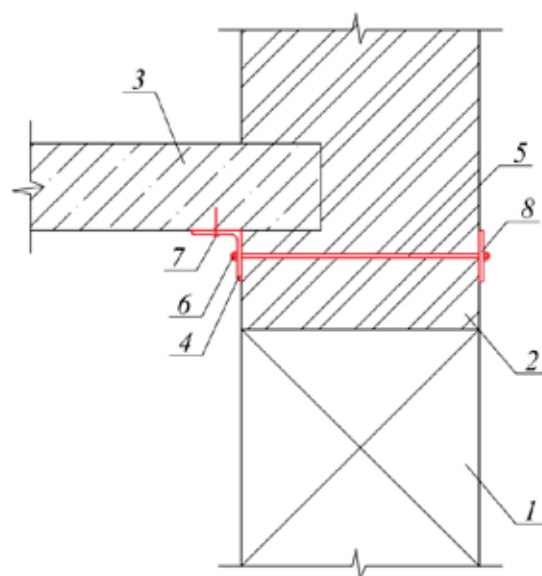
Усиление наружной стены: 1 — наружная стена ФБС; 2 — усиливаемая кирпичная кладка; 3 — плита перекрытия; 4 — металлический уголок; 5 — шпилька; 6 — стяжной болт; 7 — дюбель; 8 — металлическая планка
